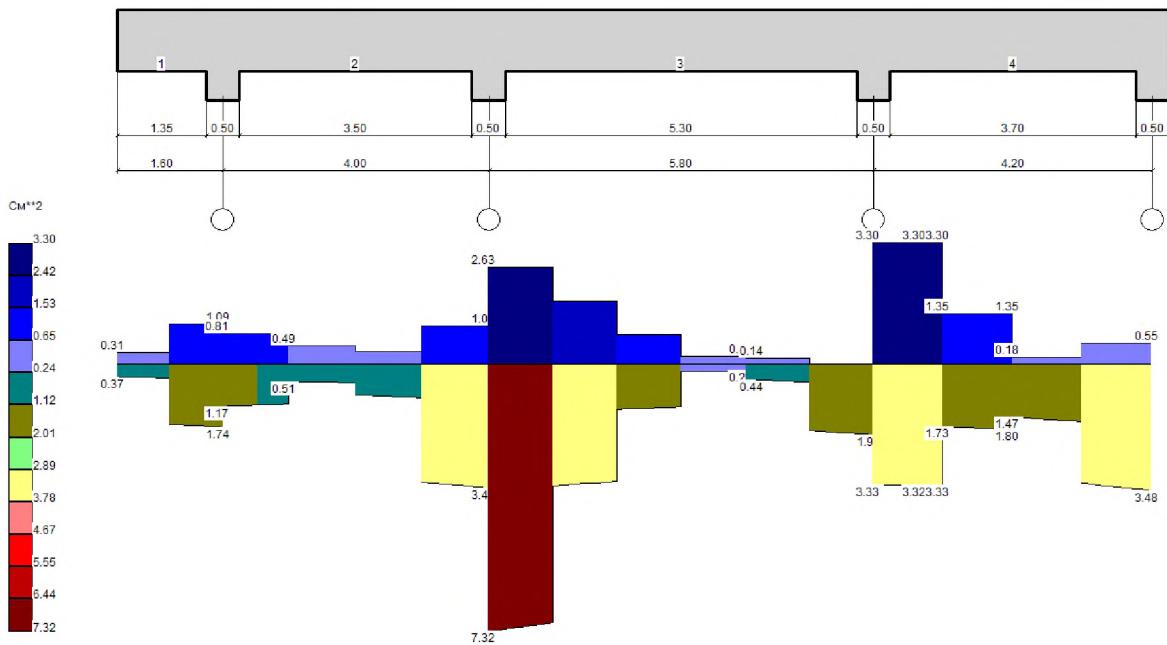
Балка № 4. Епюра поперечного армування
